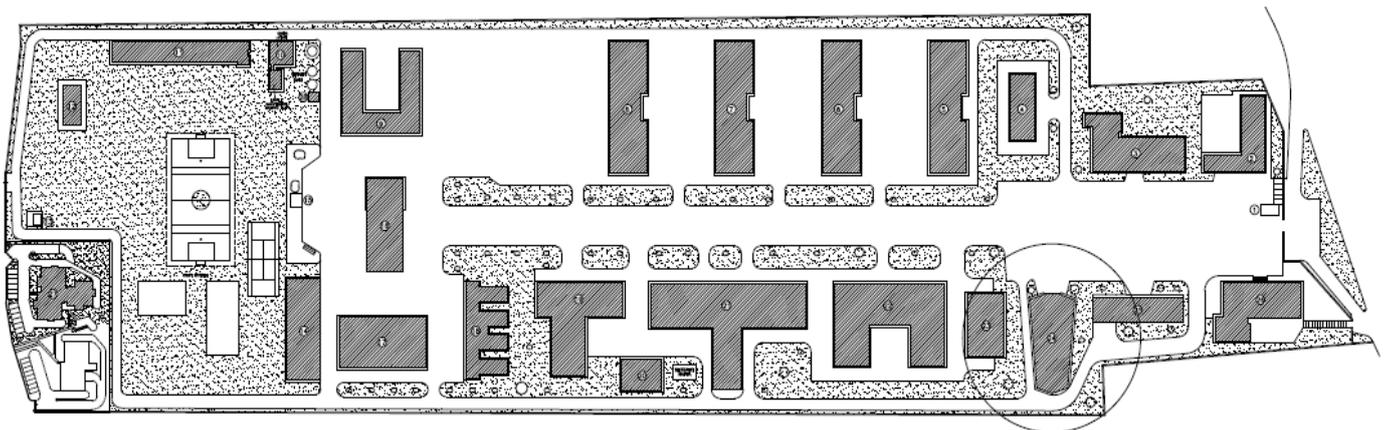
Planimetria Generale Scuola AA.CC. con indicazione palazzina 24 "Ex Cinema"
